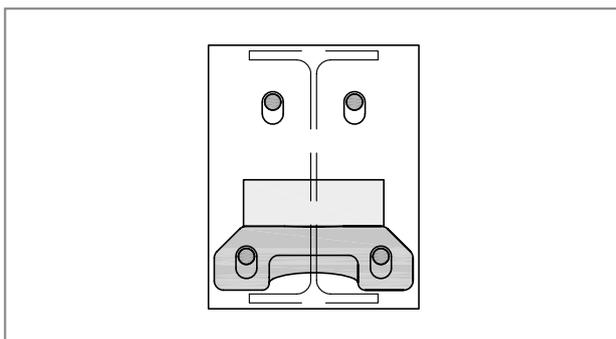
Schöck Isokorb® T type SK: On-site butt stop lies directly on the load plate
